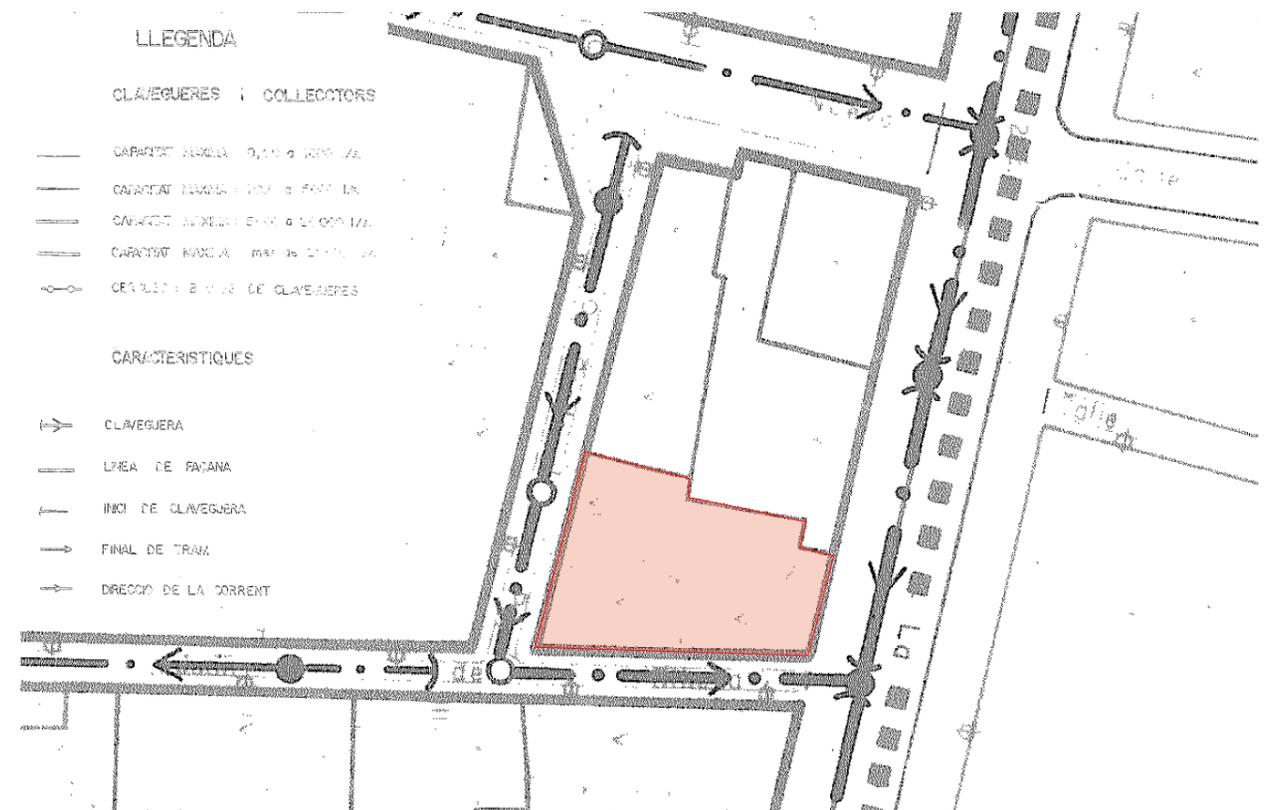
PEPRU Universitat San-Francesc. Plano O-8 Red de Alcantarillado. Zoom edificio objeto de estudio.
